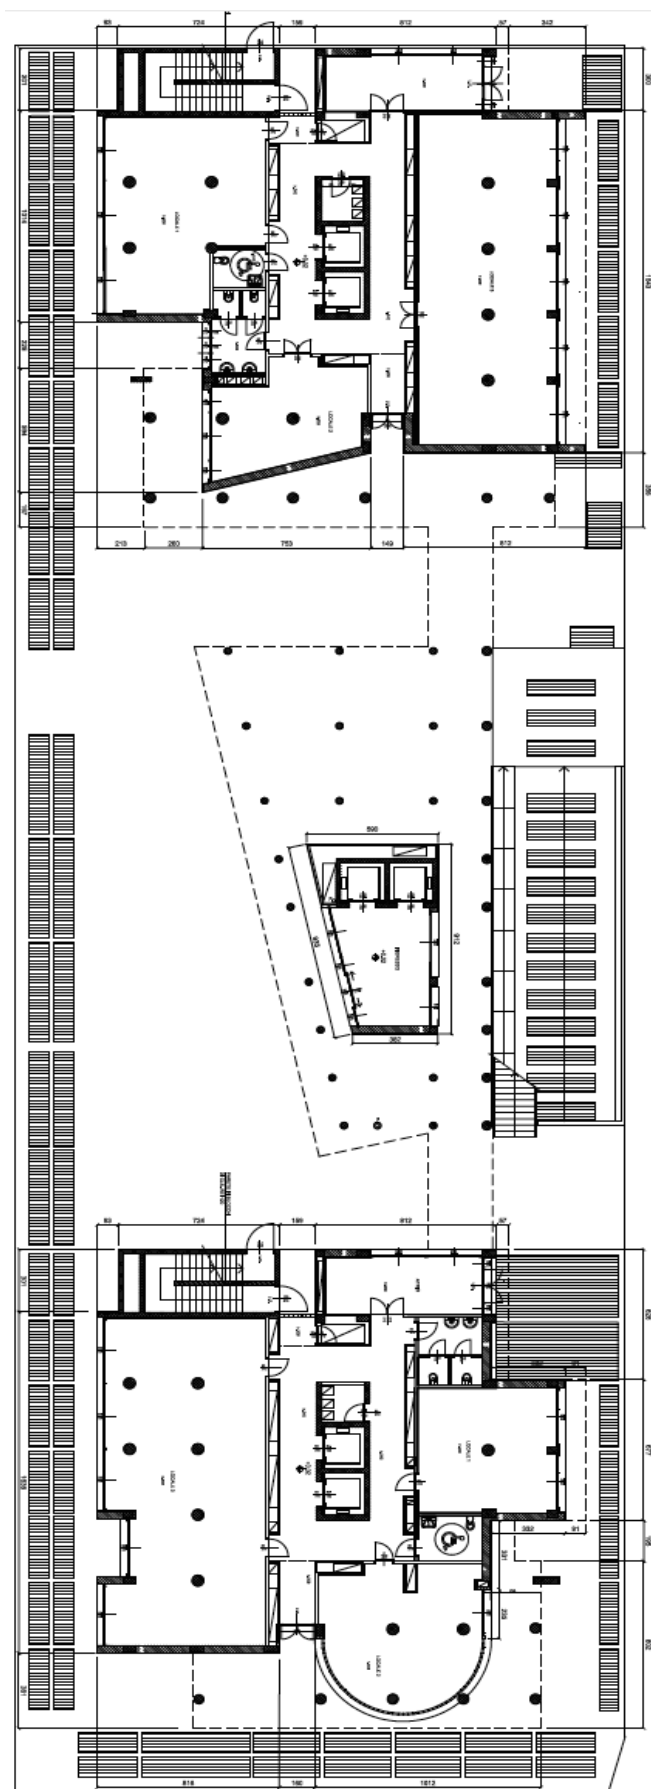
Pianta piano terra - Fonte: archivio in-domus
